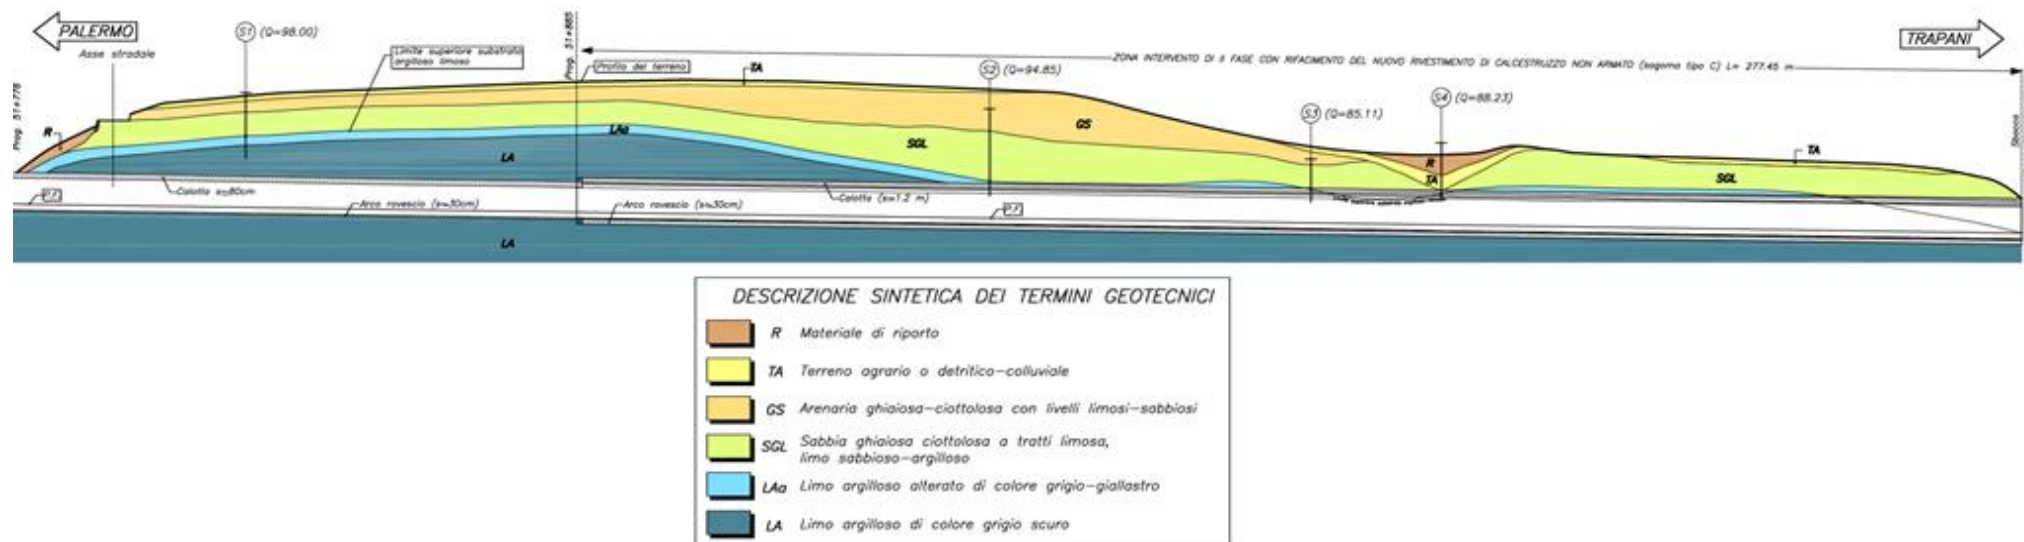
Profilo longitudinale della Galleria Spadafora con individuazione dei terreni attraversata
